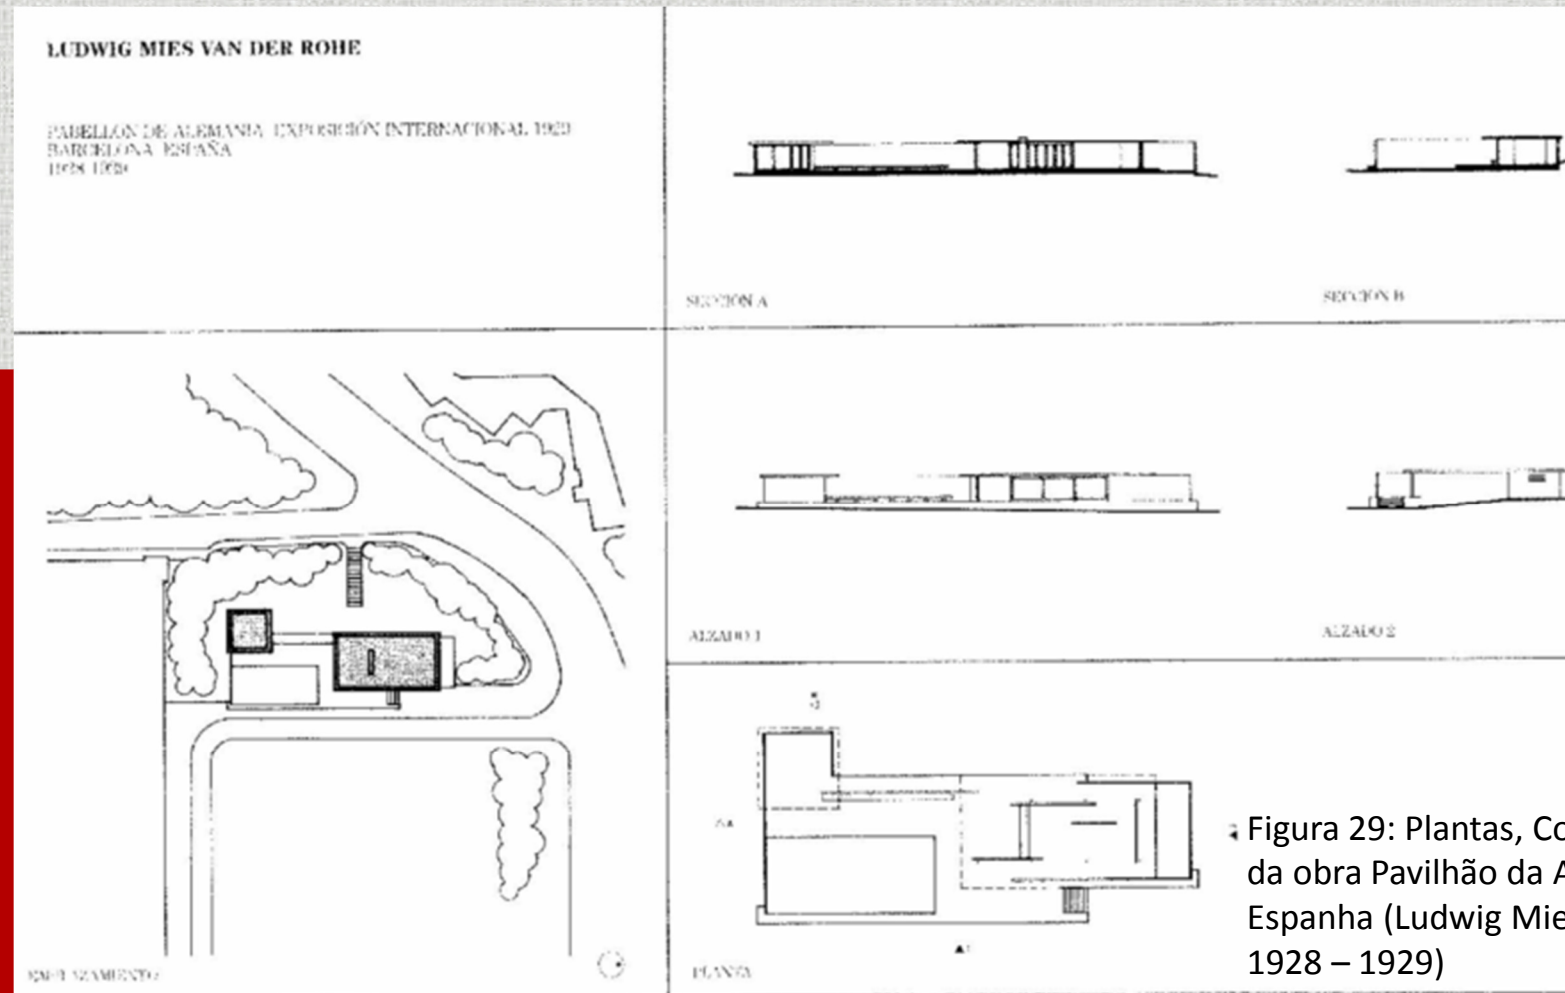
Plantas, Cortes e Fachadas da obra Pavilhão da Alemanha, Espanha (Ludwig Mies van der Rohe, 1928 – 1929)
